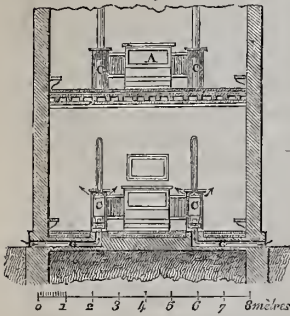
Coupe en travers du bâtiment; vue prise en regardant l'estrade.
